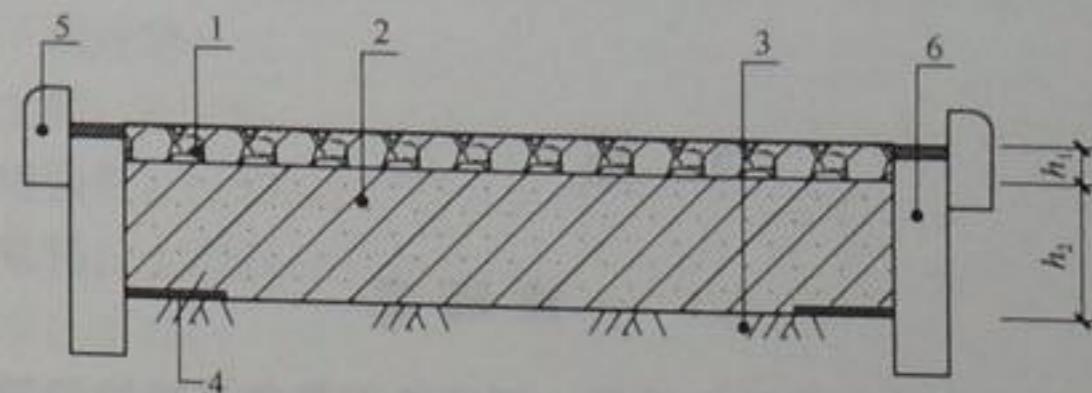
透水水泥混凝土路面排水形式（横断面）
